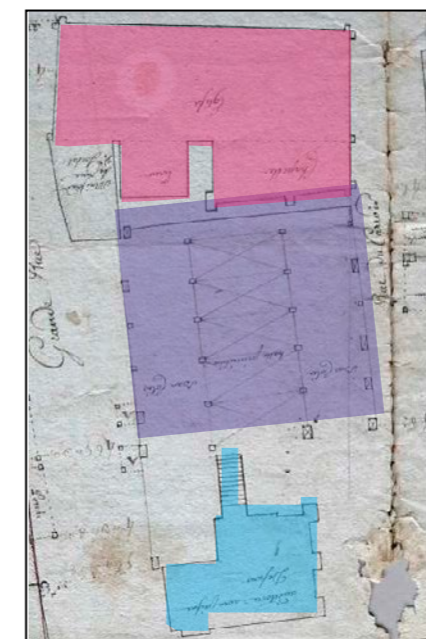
Plan des halles, la prison et l'ancienne chapelle (source : AM SADC, C-10 3)
